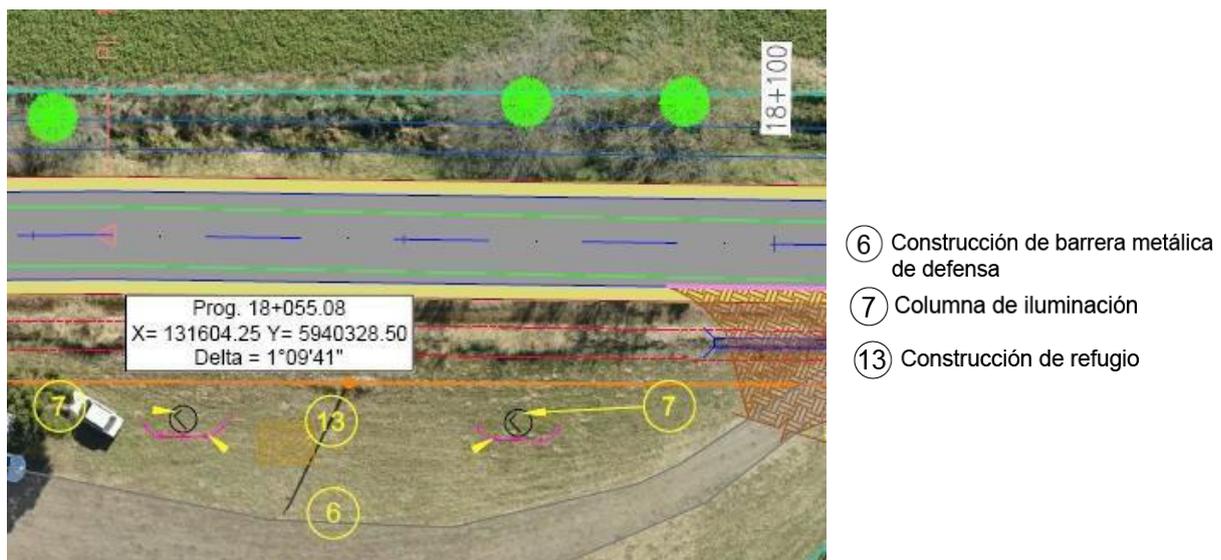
Refugio Pr. 18+065. Extraído del Plano del Proyecto de Ingeniería CR-CASBAS-CASEY-1.2.7-PLANILATIMETRIAS-00
